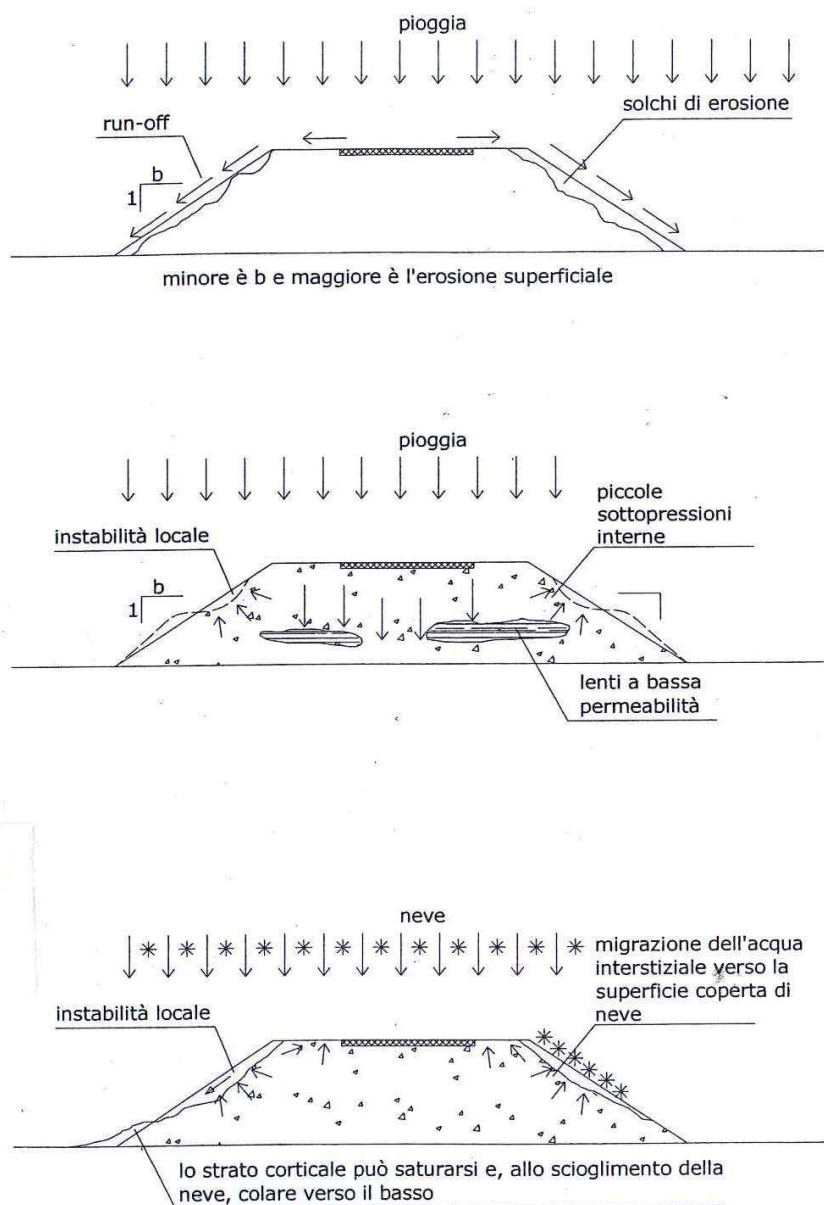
Instabilità delle scarpate del rilevato e rotture diffuse nella pavimentazione.
